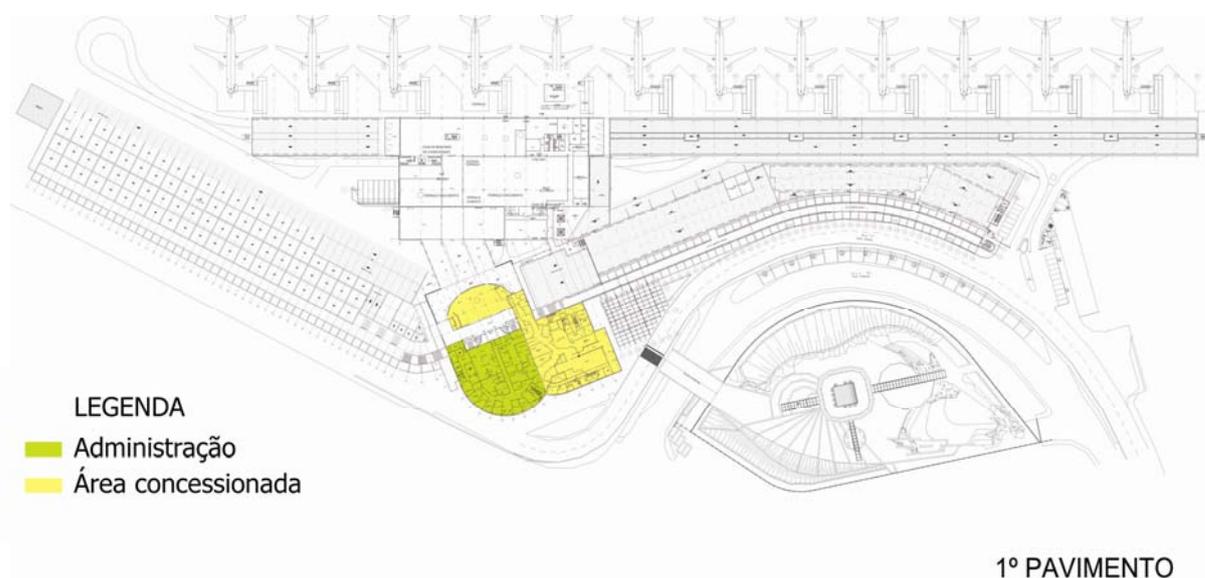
Planta do 1º pavimento. Fonte: INFRAERO, 2008.
